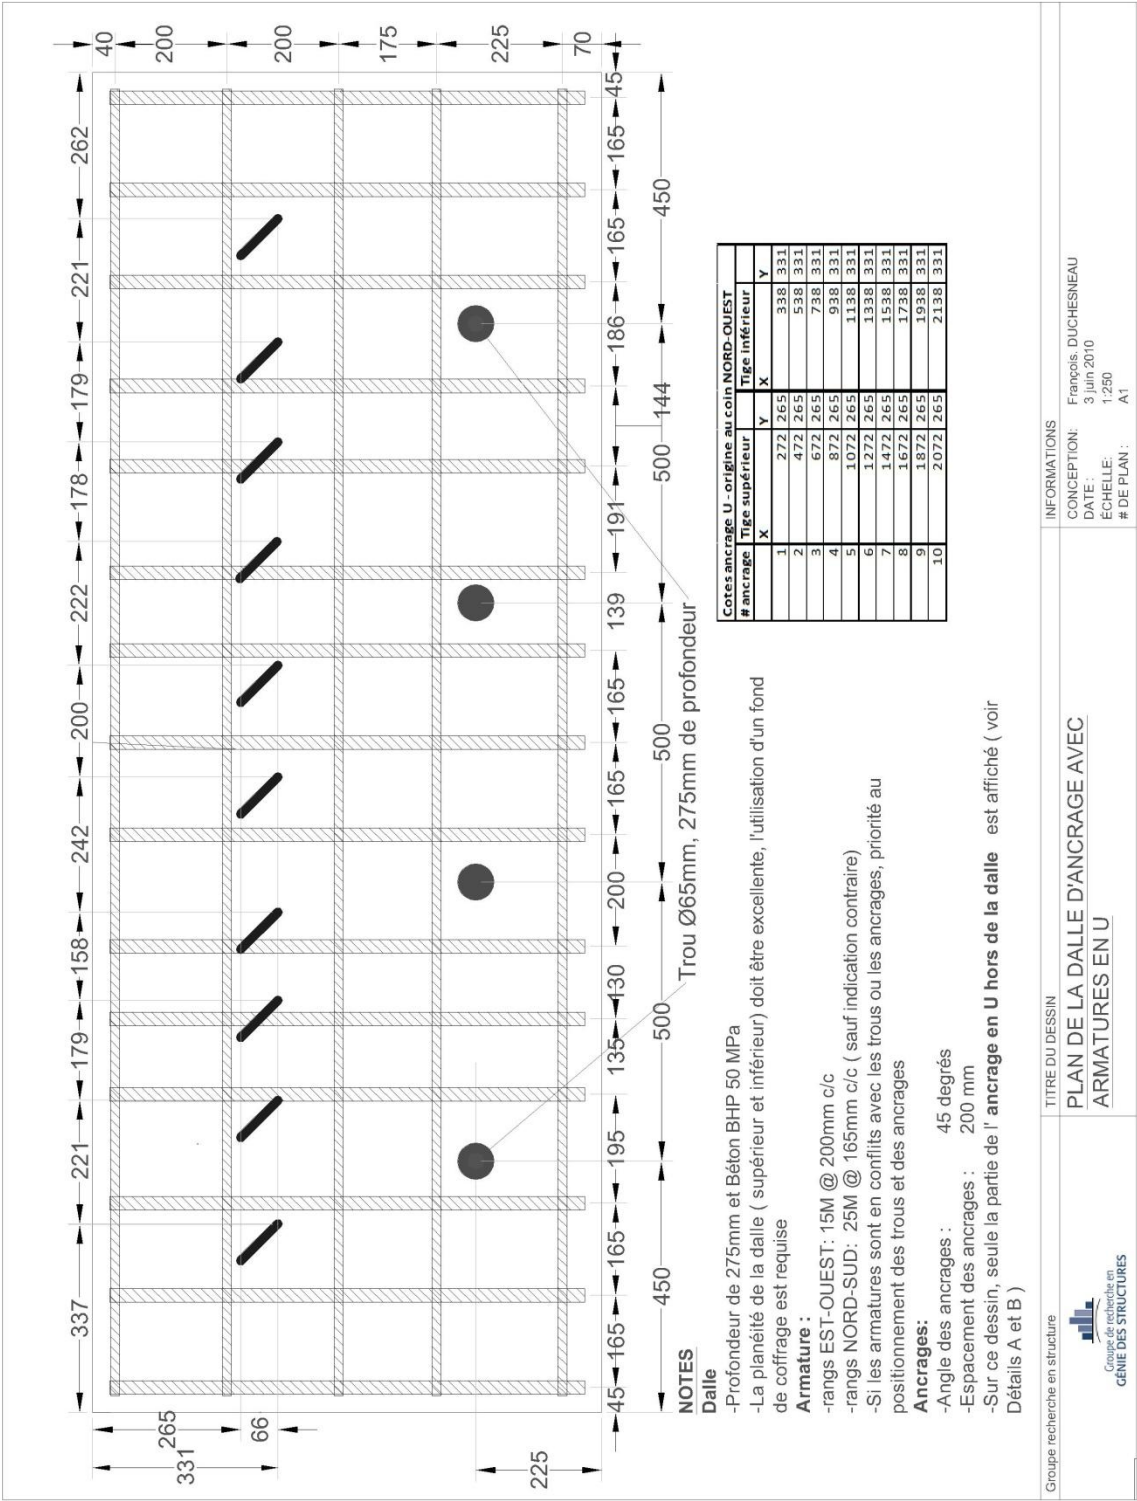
Plan de la dalle d’ancrage avec armatures en U
